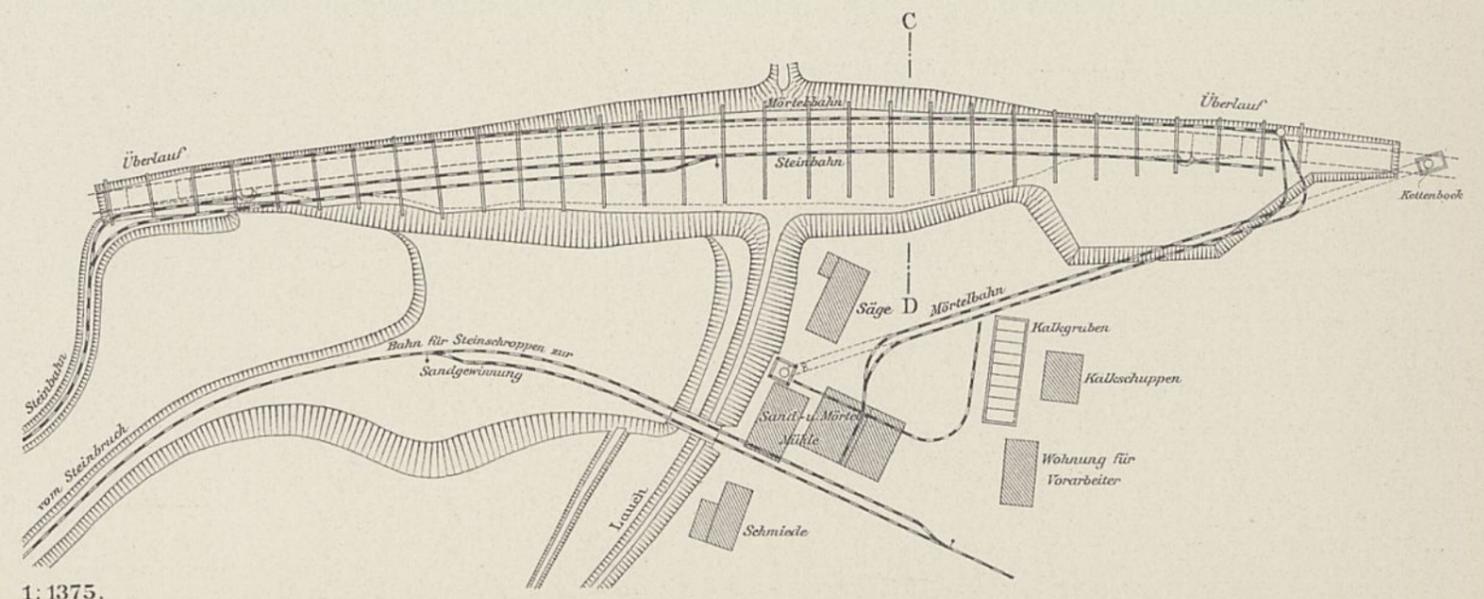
Lageplan für die Gleisanlage im Jahre 1894. 1 : 1375.
